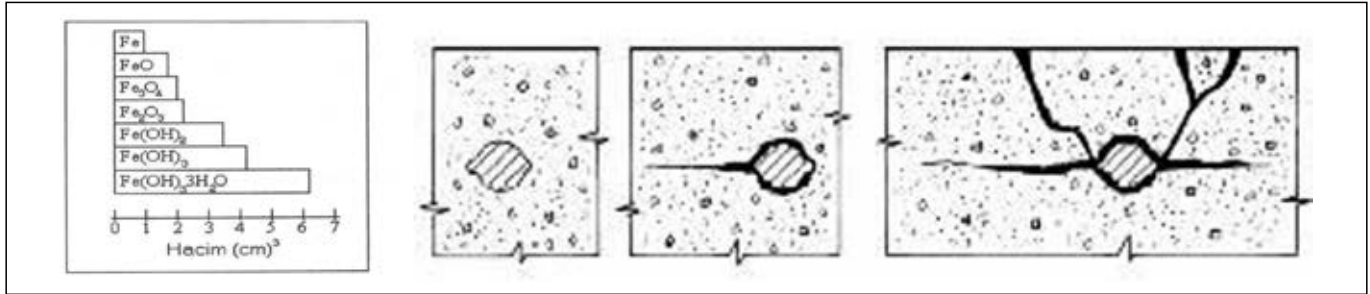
Donatıyı koruyan beton pas payı tabakası
